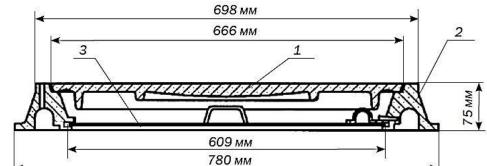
Детали и размеры люка лёгкого типа по ГОСТ 8591-76.
